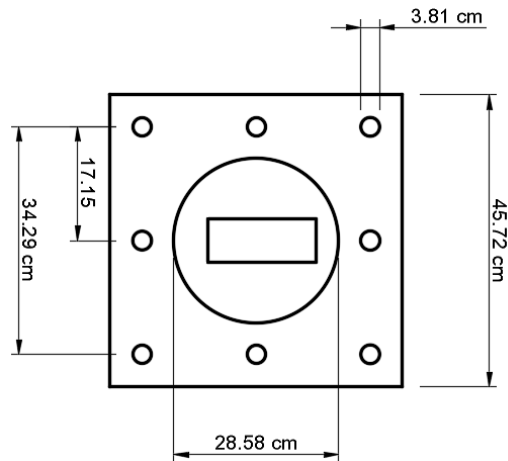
Dimensiones de placa de disipador 440 KIP (Fuente propio)
